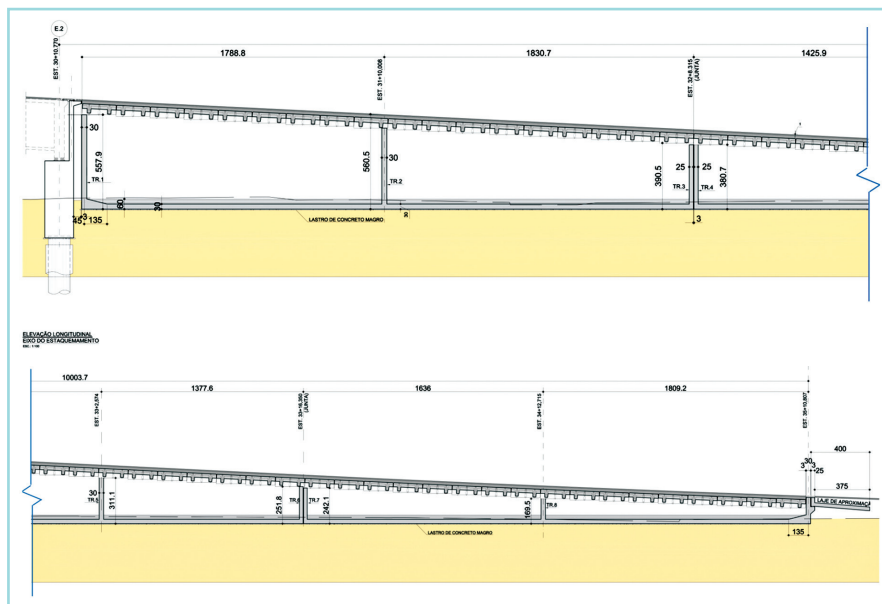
ELEVAÇÃO – ENCONTRO 2
